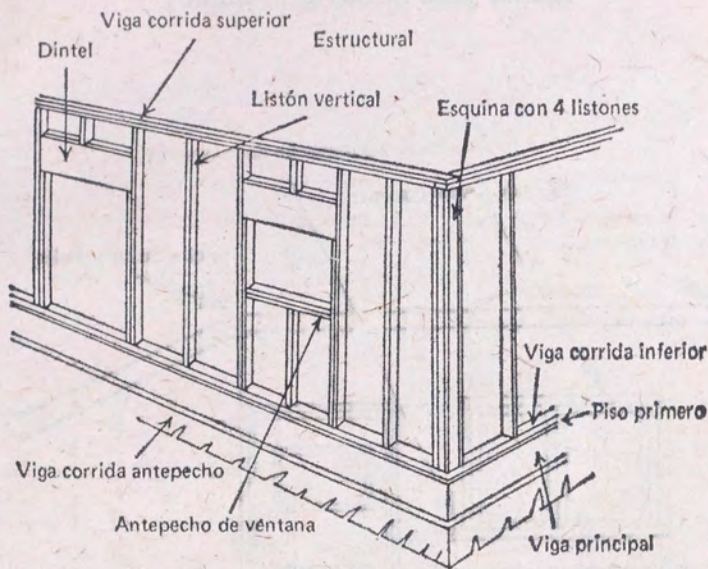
Procedimiento y plano para la construcción de una casa con madera.
